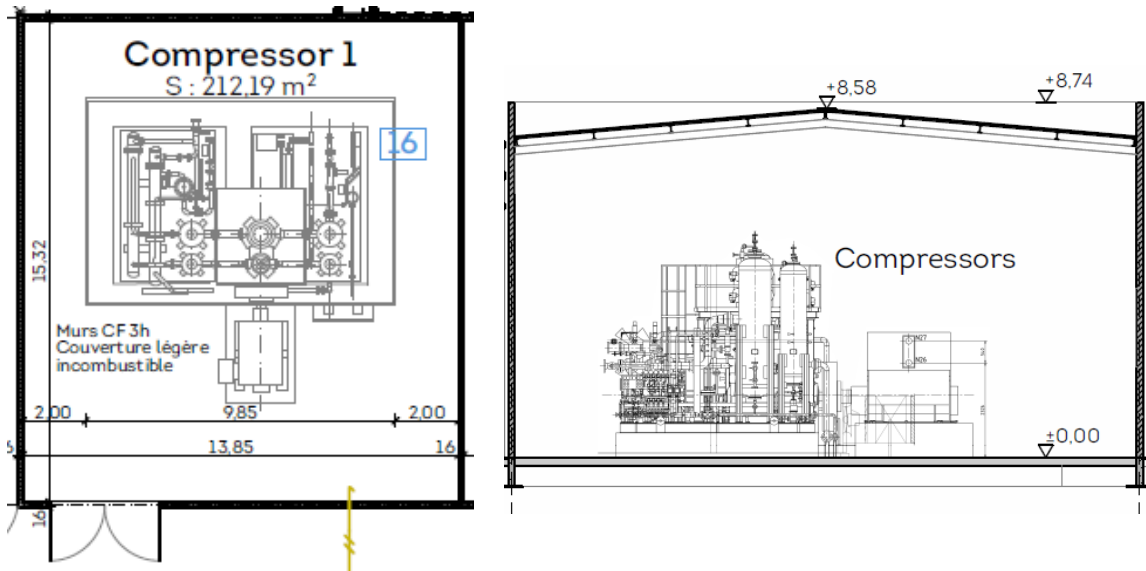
Plan du bâtiment compresseur : vue en plan (à gauche) et en coupe (à droite)
